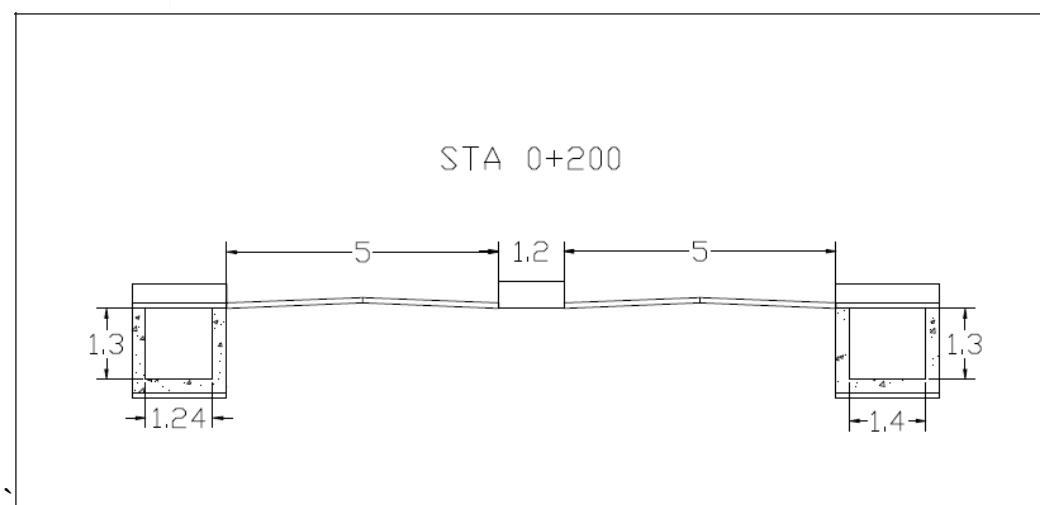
Lay out Jalan Jenderal Sudirman
